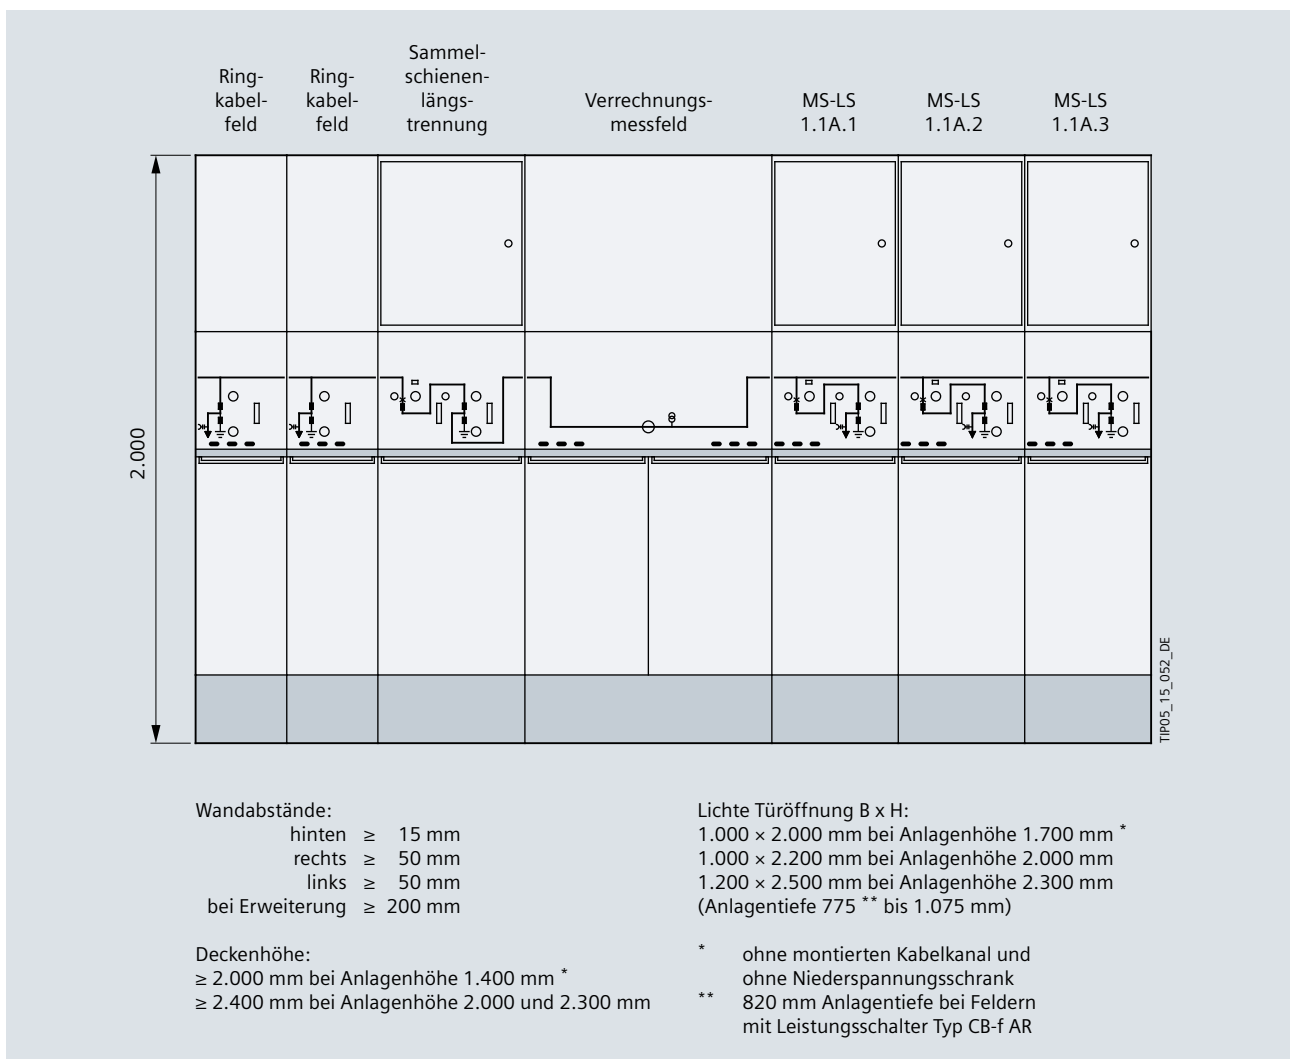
/3: Frontansicht für Mittelspannungsschaltanlage 8DJH
